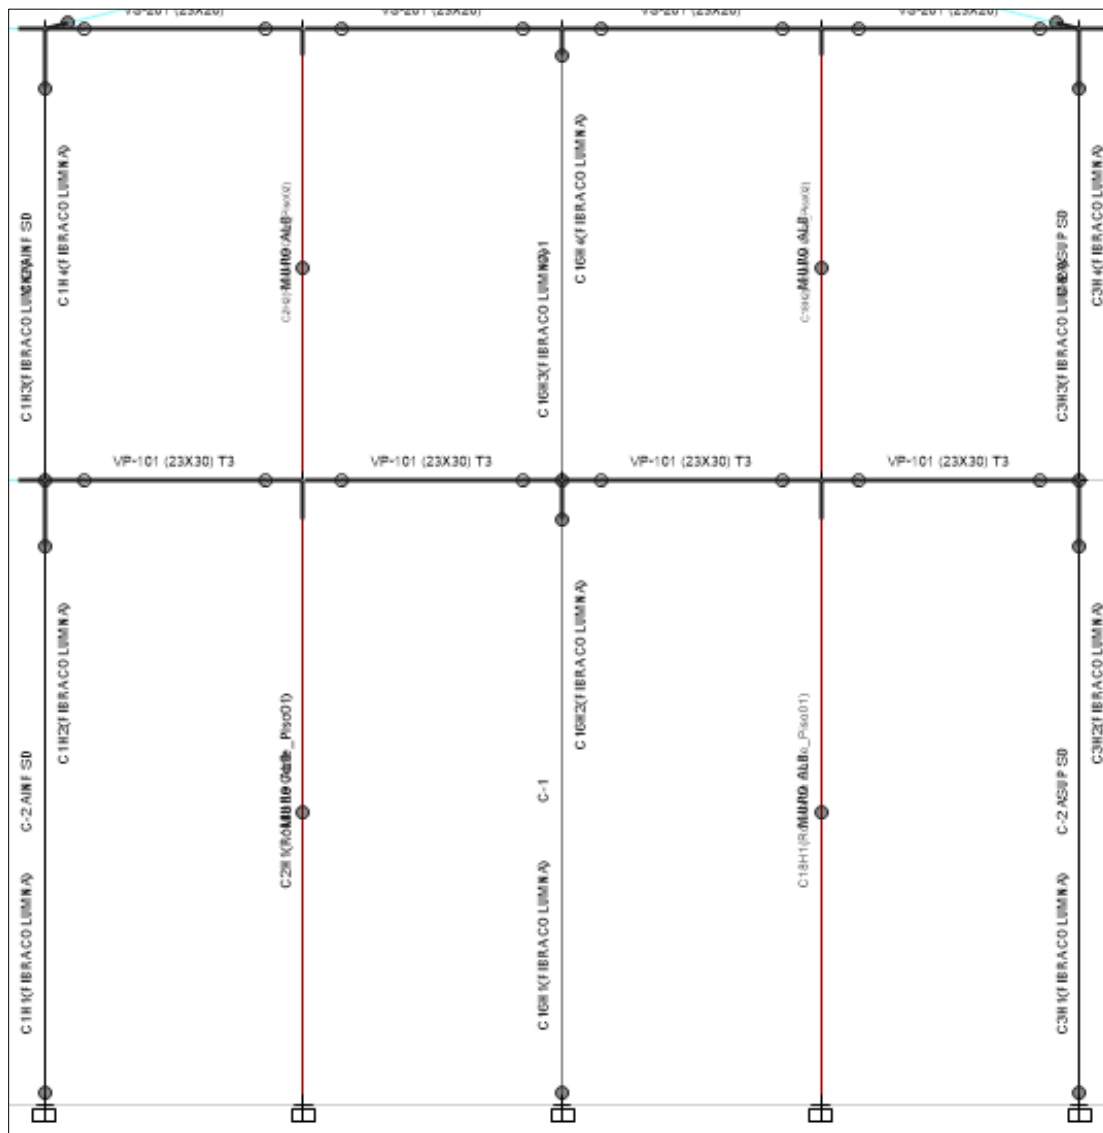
Elevación del muro de albañilería confinada equivalente – modelado con elemento tipo “frame”
